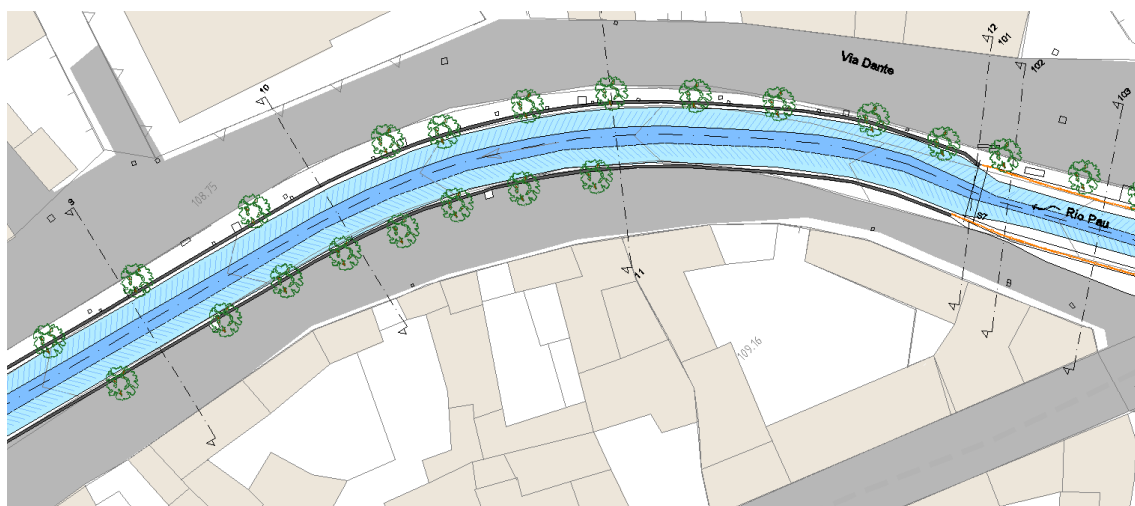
Posizione sulla planimetria di rilievo delle sezioni 9-12 (vedi tav. DT03). Nella parte destra della planimetria ha inizio la sistemazione proposta nel presente nel progetto definitivo.
